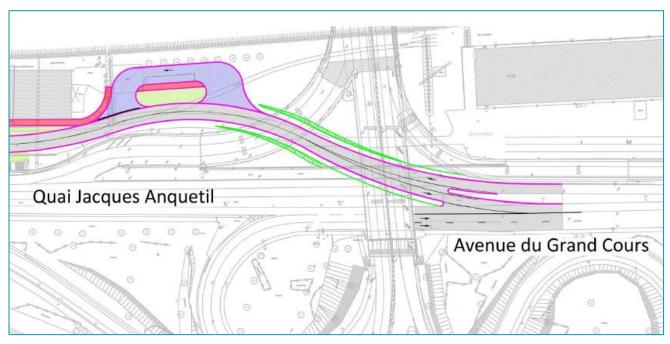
Plan du raccordement de la nouvelle voirie sur l'avenue du Grand Cours
